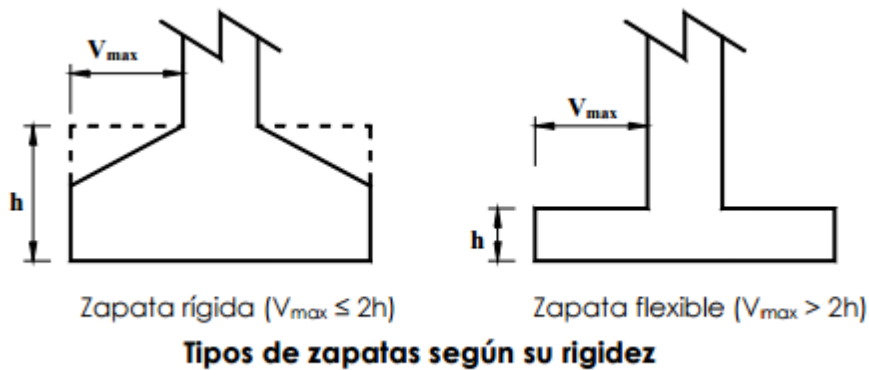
Tipos de zapatas según su rigidez como son: Zapata rígida y zapata flexible.
